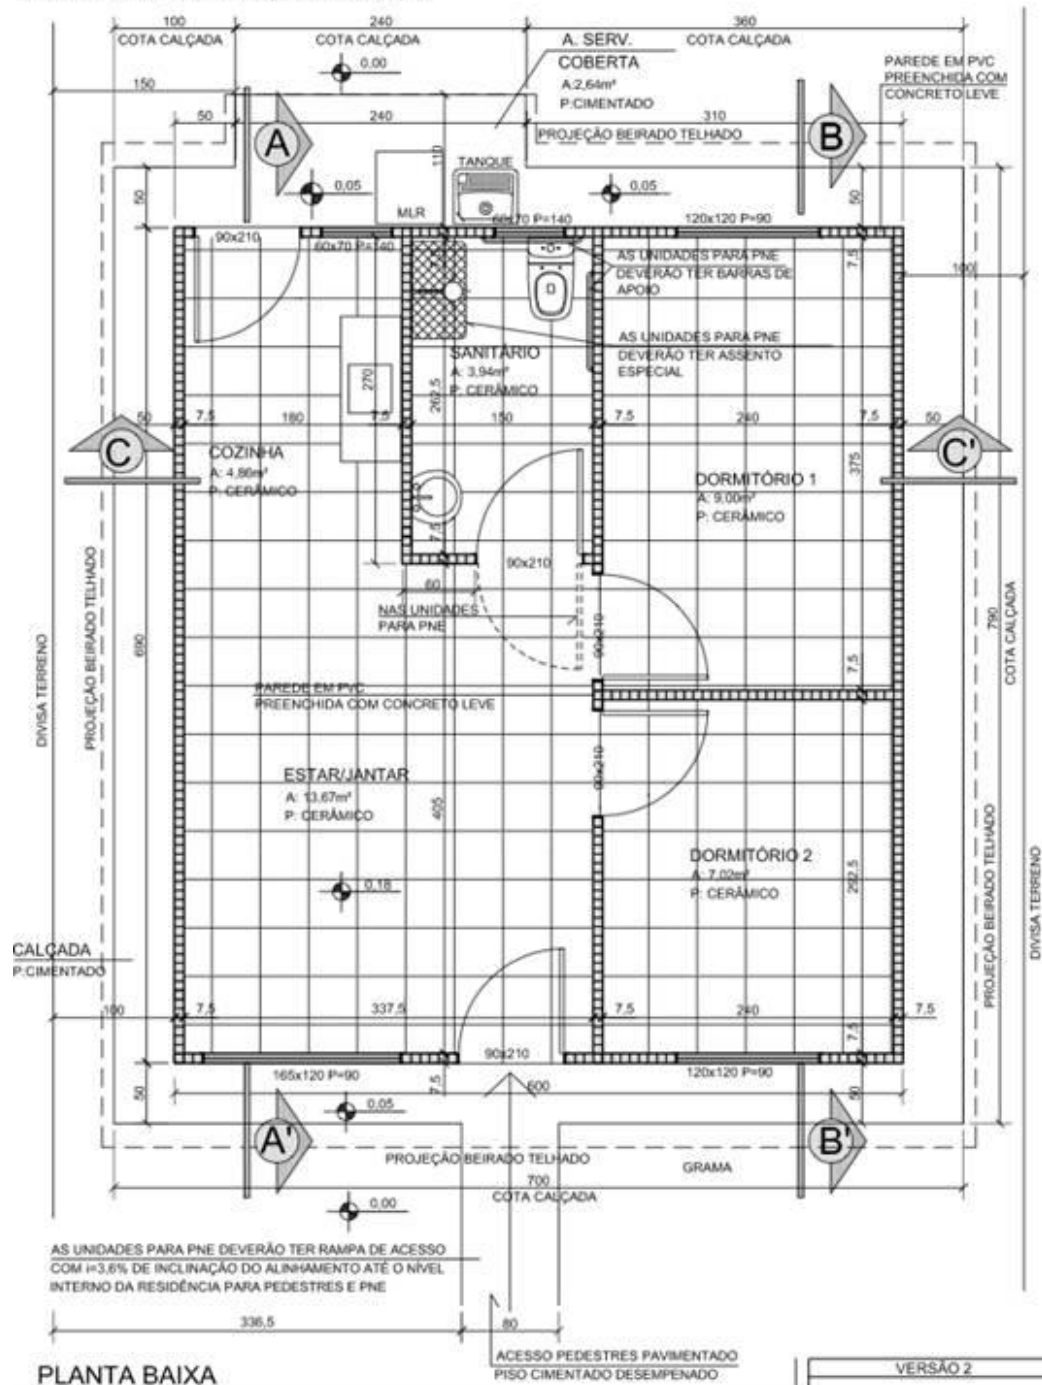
Planta Baixa: Loteamento Parque Novo Hamburgo/ Fase III e IV.
